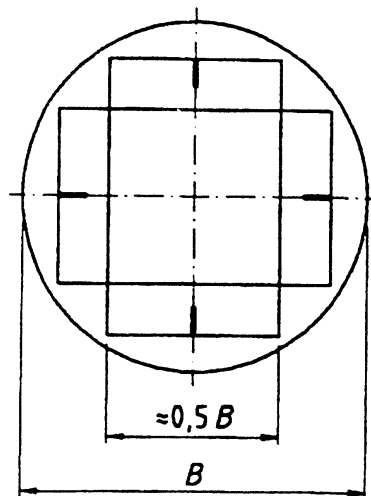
Armatures orthogonales dans une semelle circulaire fondée sur le sol
